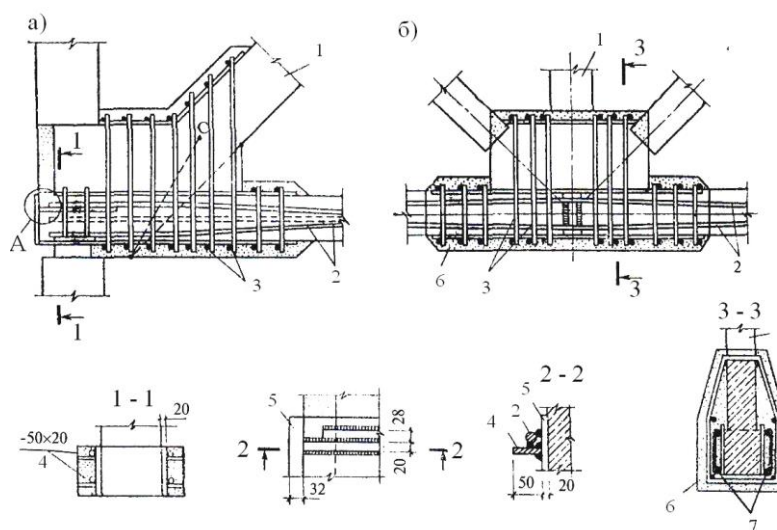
Усиление узловых сопряжений железобетонной фермы устройством железобетонных обойм: а) – опорного узла; б) – центрального узла:
